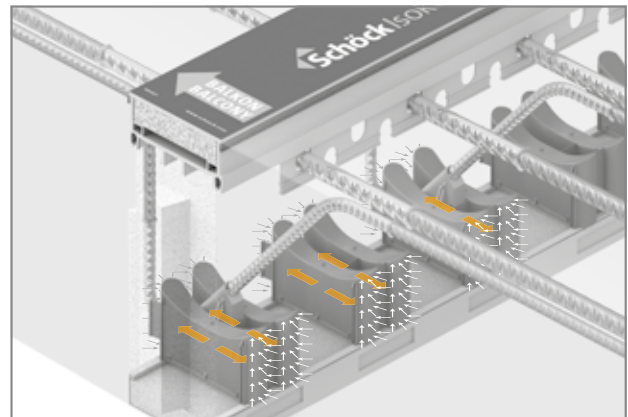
Schöck Isokorb® tip K: priprava opaža in armature za betoniranje. Stik vgrajenega betona s steno = spodnji rob opaža balkona!
